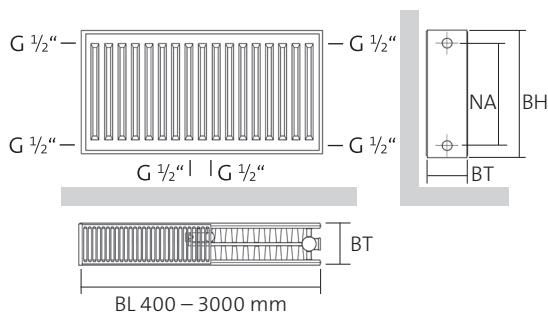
Ventil Compact M 6-Muffen-Profilheizkörper mit Mittenanschluss
